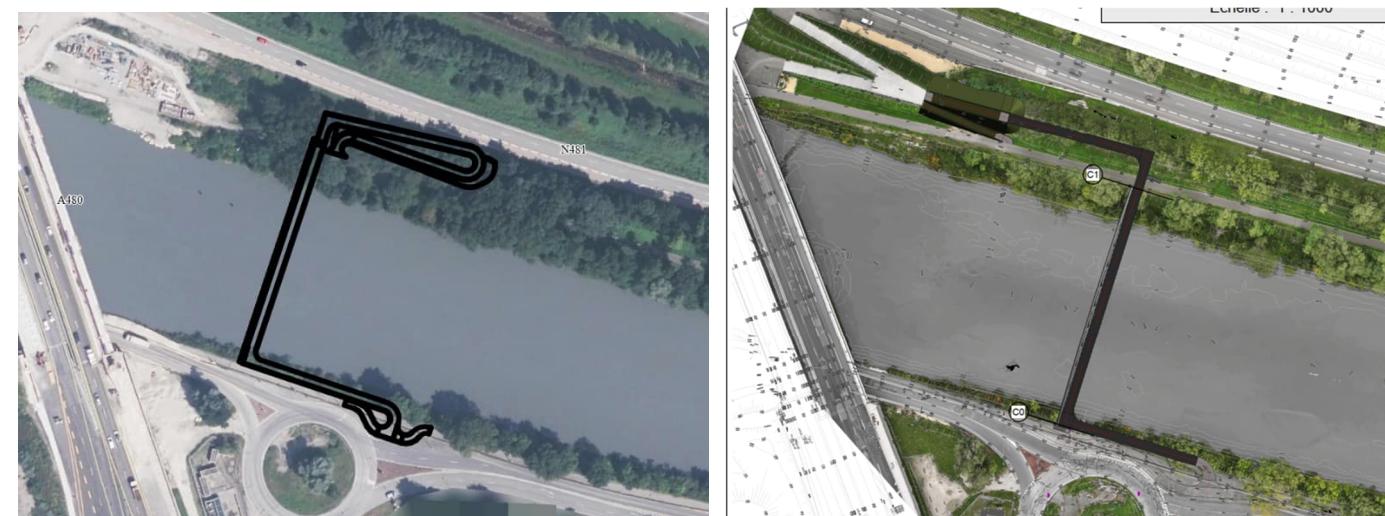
Implantation initiale de la rampe en rive droite (à gauche) et modification de projet au profit de l'utilisation des aménagements existants (à droite)
